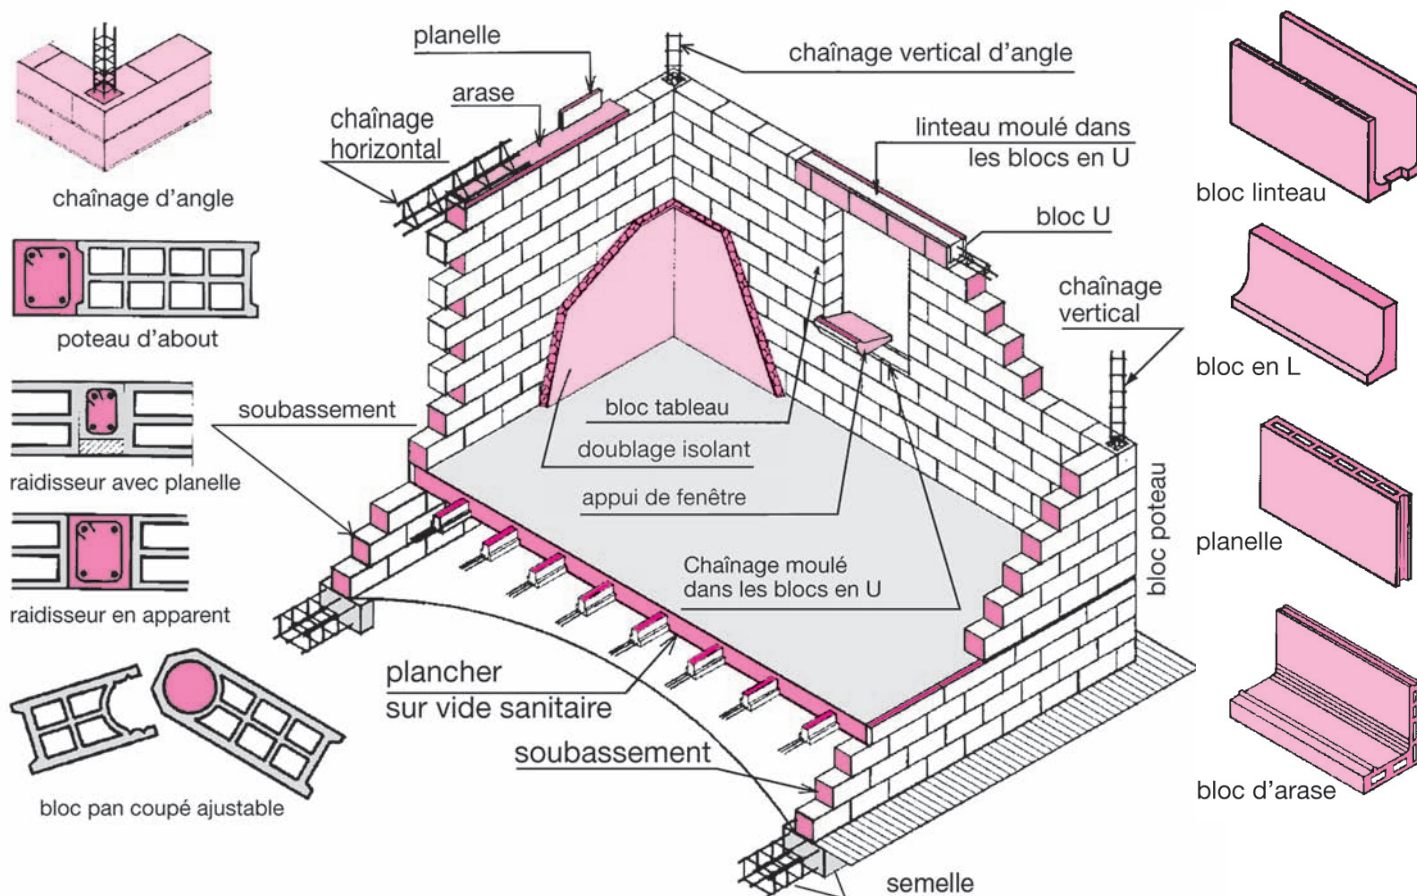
Système constructif par blocs en béton et poutrelles précontraintes
